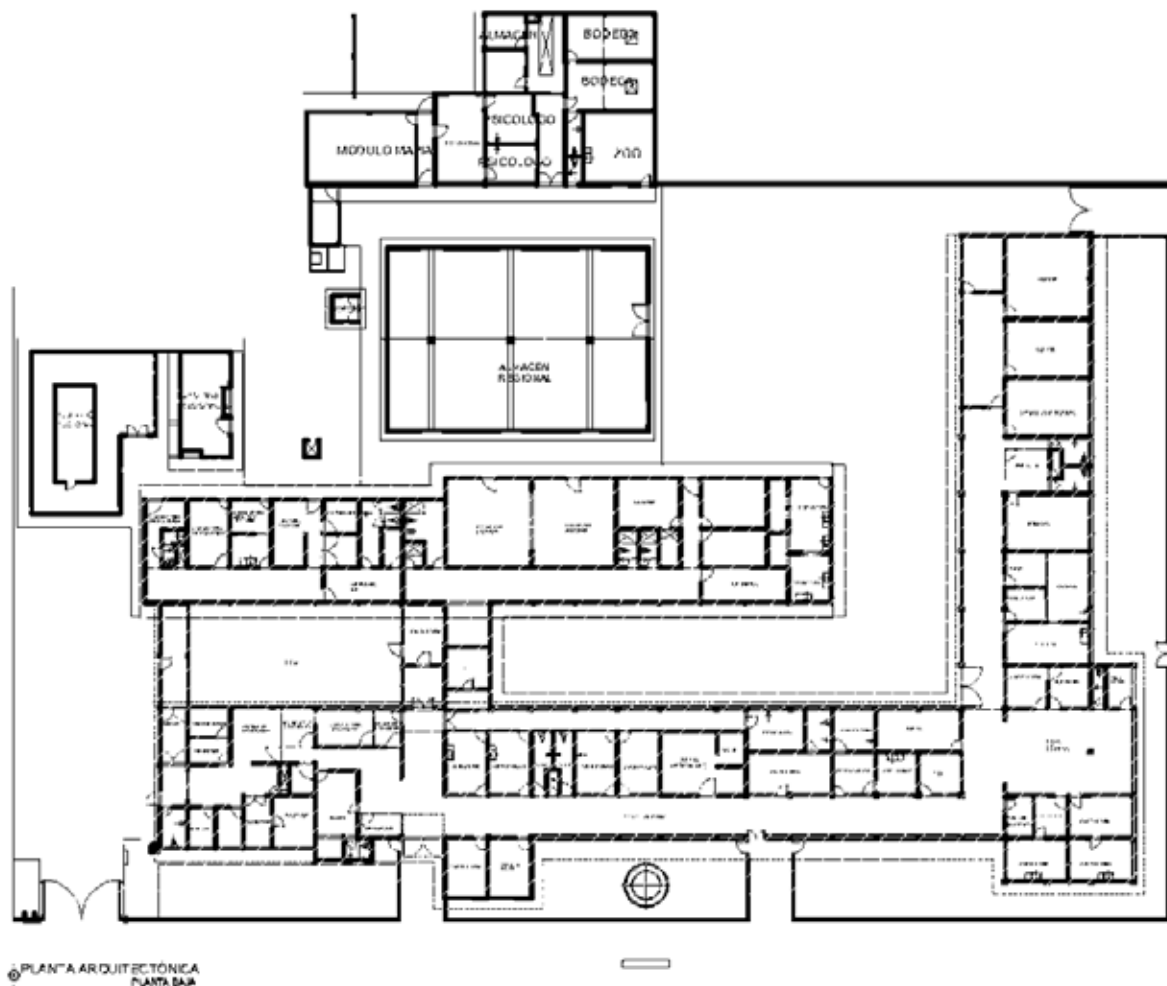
Planta Arquitectónica. Del Centro de Salud de Zitácuaro 03-02-2020. Fuente: secretaria de Salud 2020.
